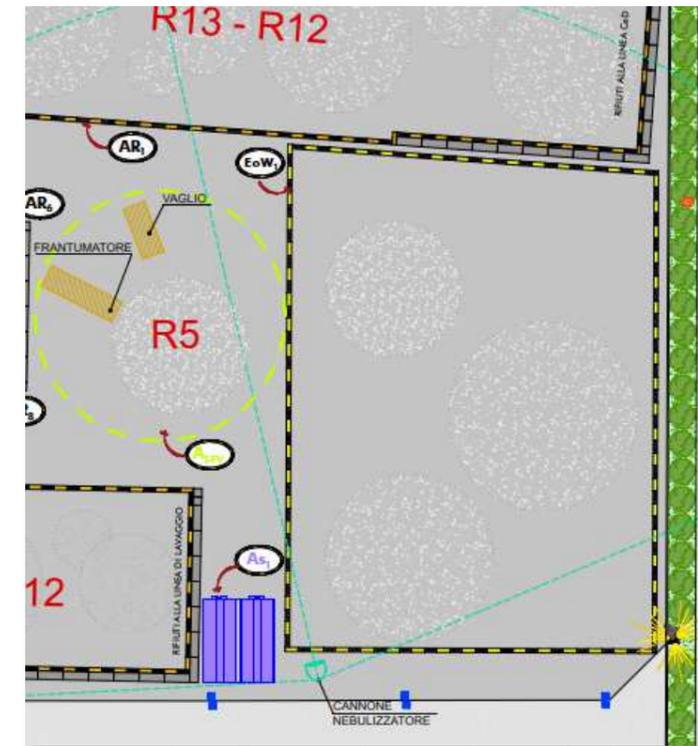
Stralcio planimetria con aree dedicate allo stoccaggio degli End of Waste
